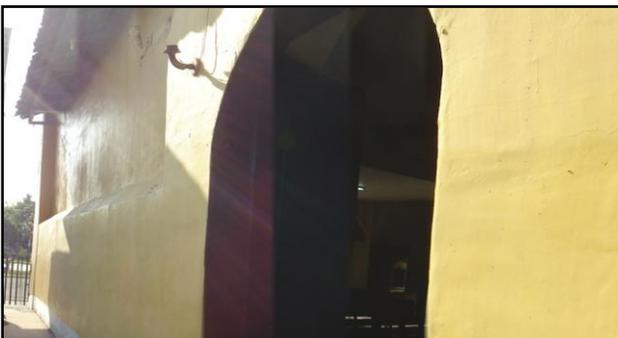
Muros y Zócalos de la Parroquia de Quezalaguaque. Autor (2010).
